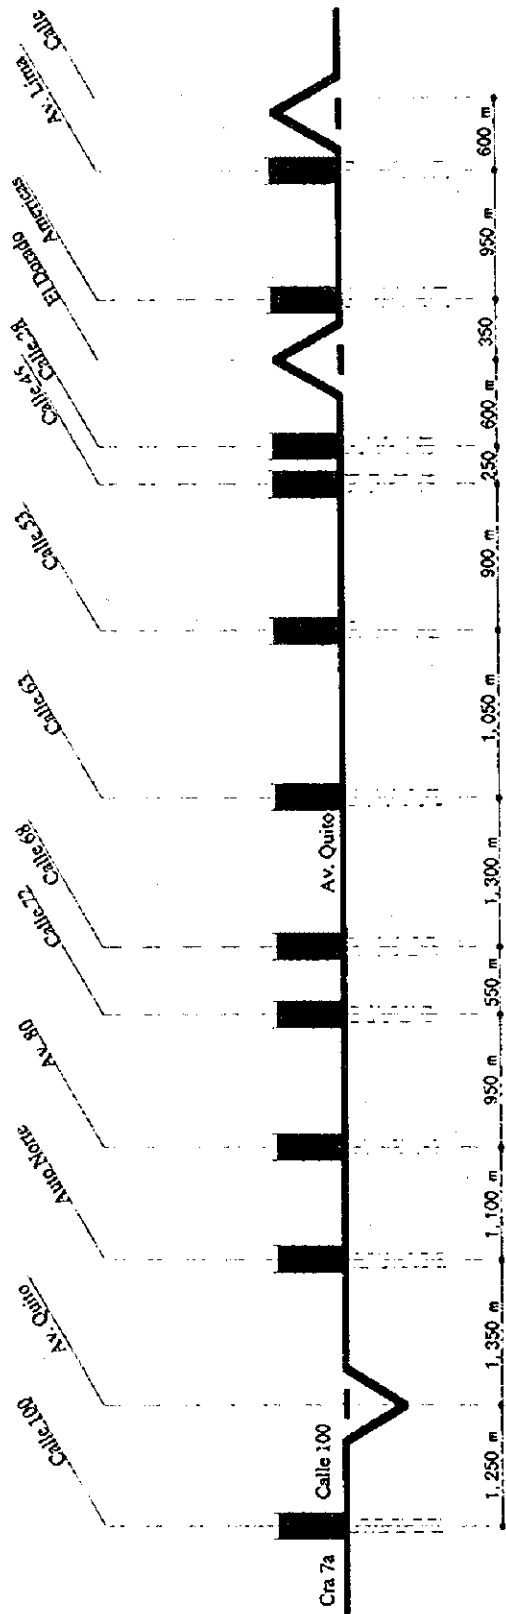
Ubicación de Puentes elevados en la Avenida Quito
